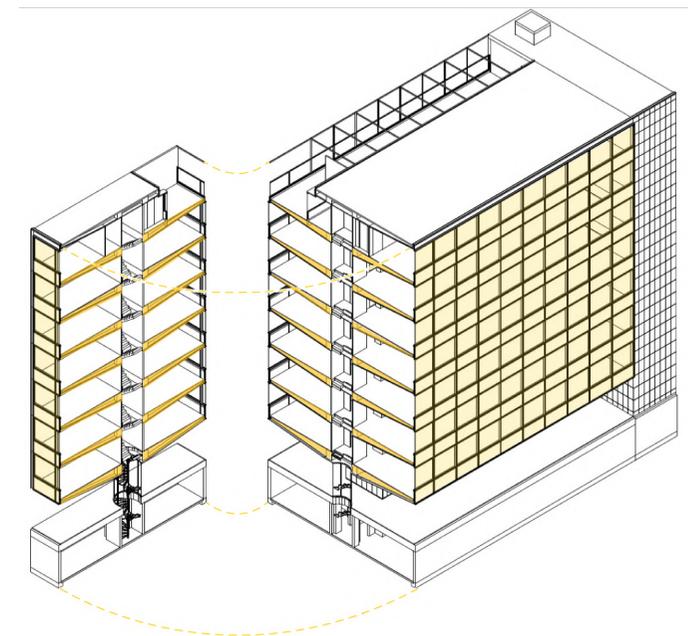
33: Planta tipo edificio Kontorhus Jesoersen Og Son Nyropsgade 18 (Espacios amplios y separación de sistemas). Fuente: Estructura y detalle en la obra de Arne Jacobsen
